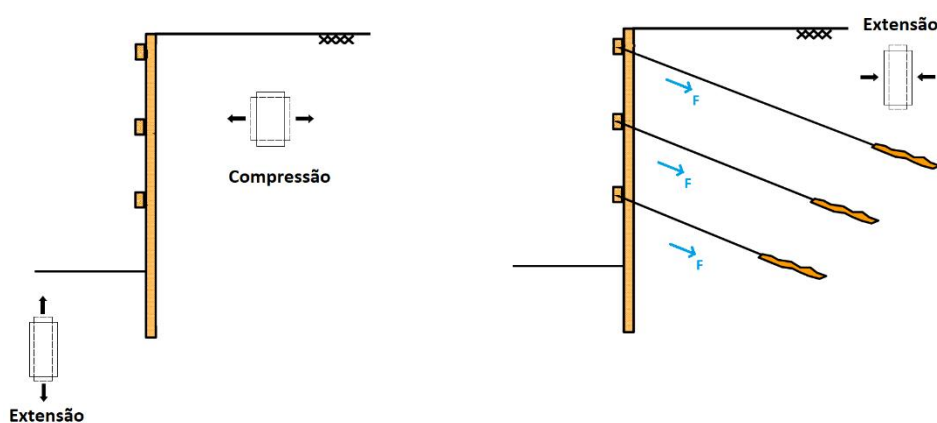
Trajetórias de tensões originadas num maciço pela construção de uma estrutura de suporte de escavação.
